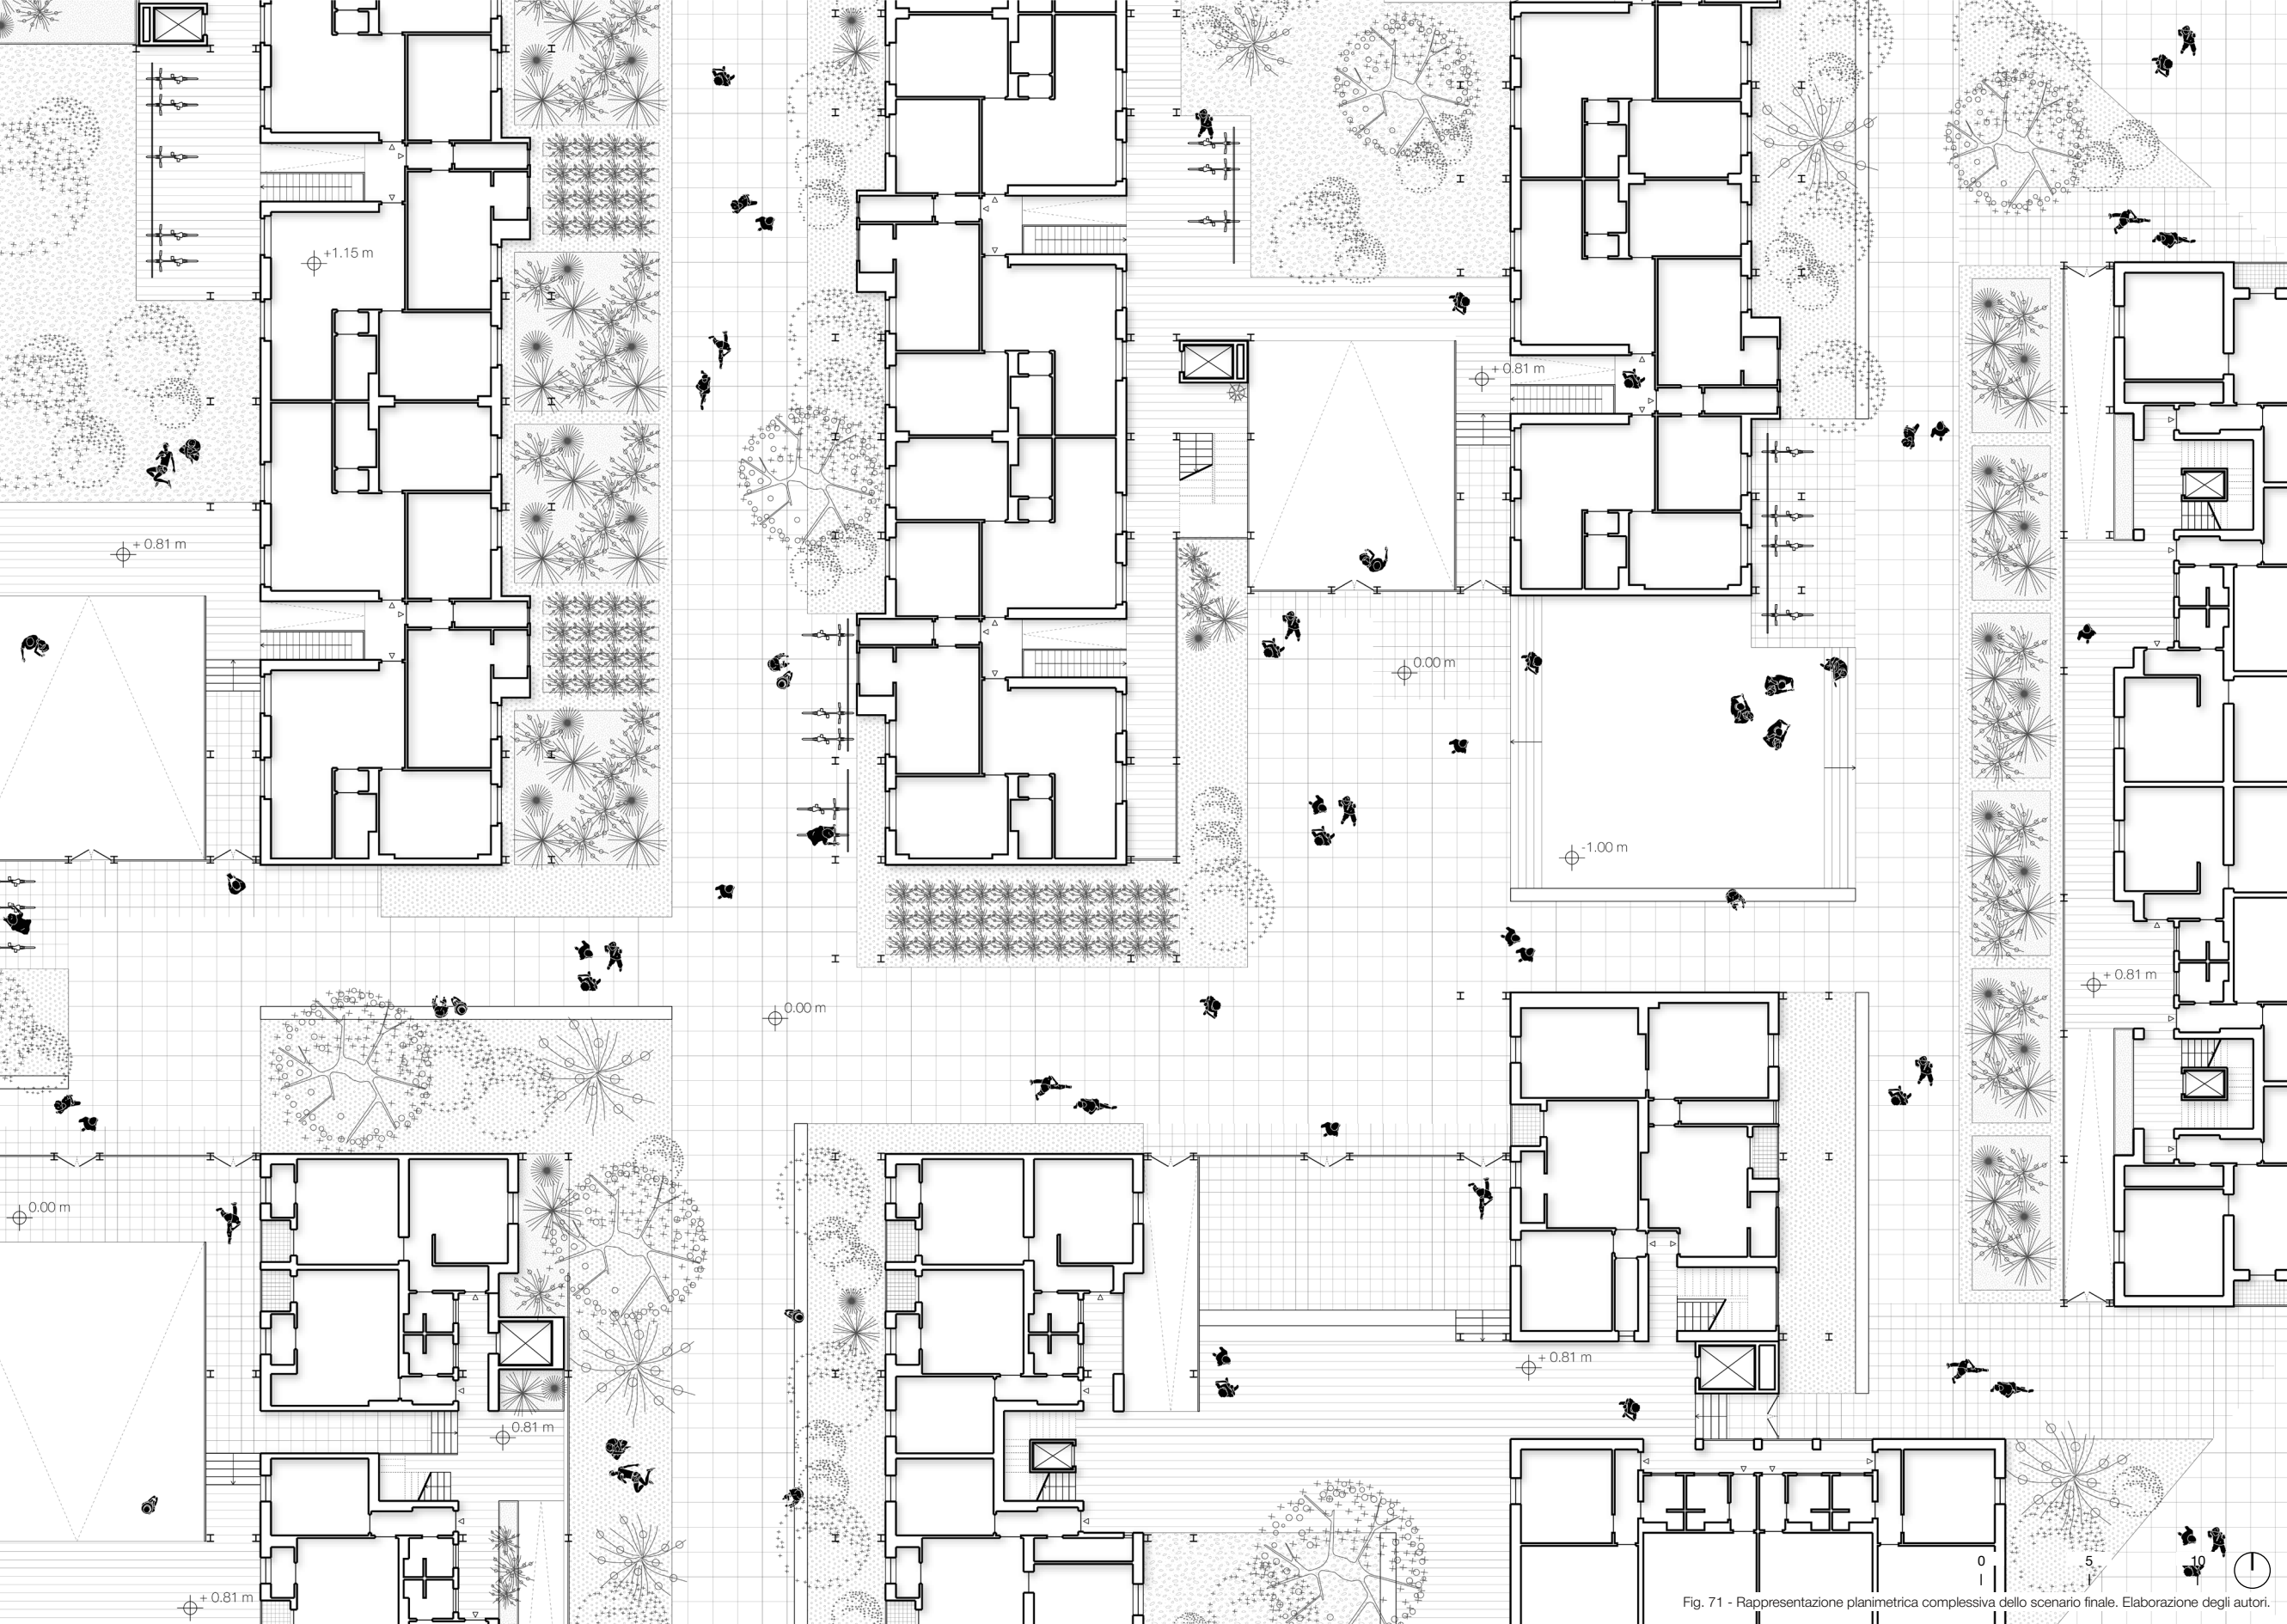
Rappresentazione planimetrica complessiva dello scenario finale. Elaborazione degli autori.
